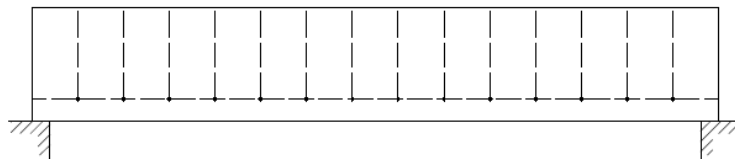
5 Viga de hormigón armado con refuerzo longitudinal y transversal.
